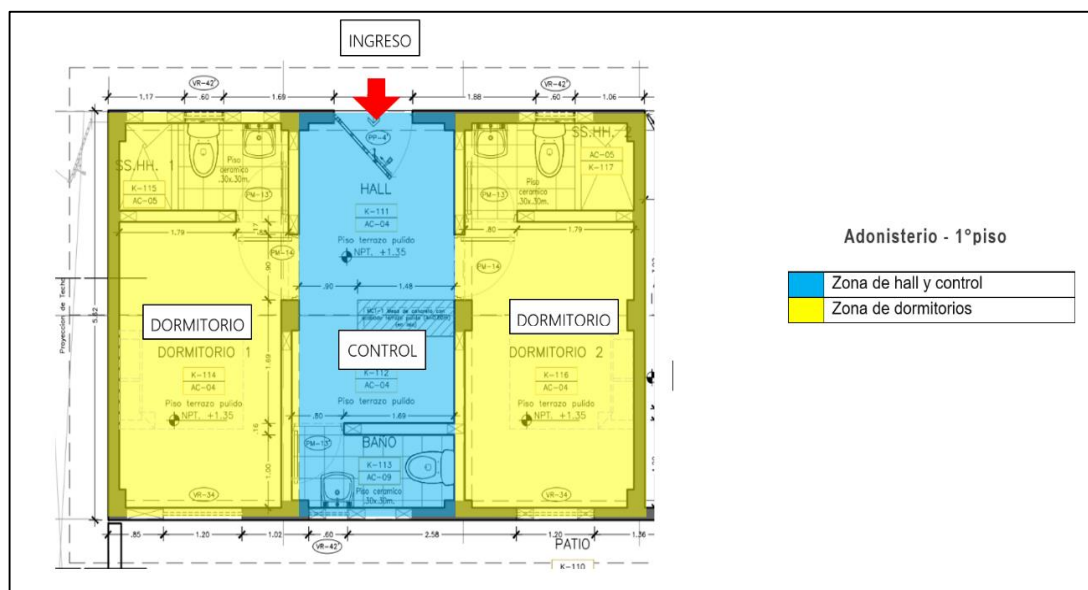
Planta 1er piso Adonisterio – Mujeres
